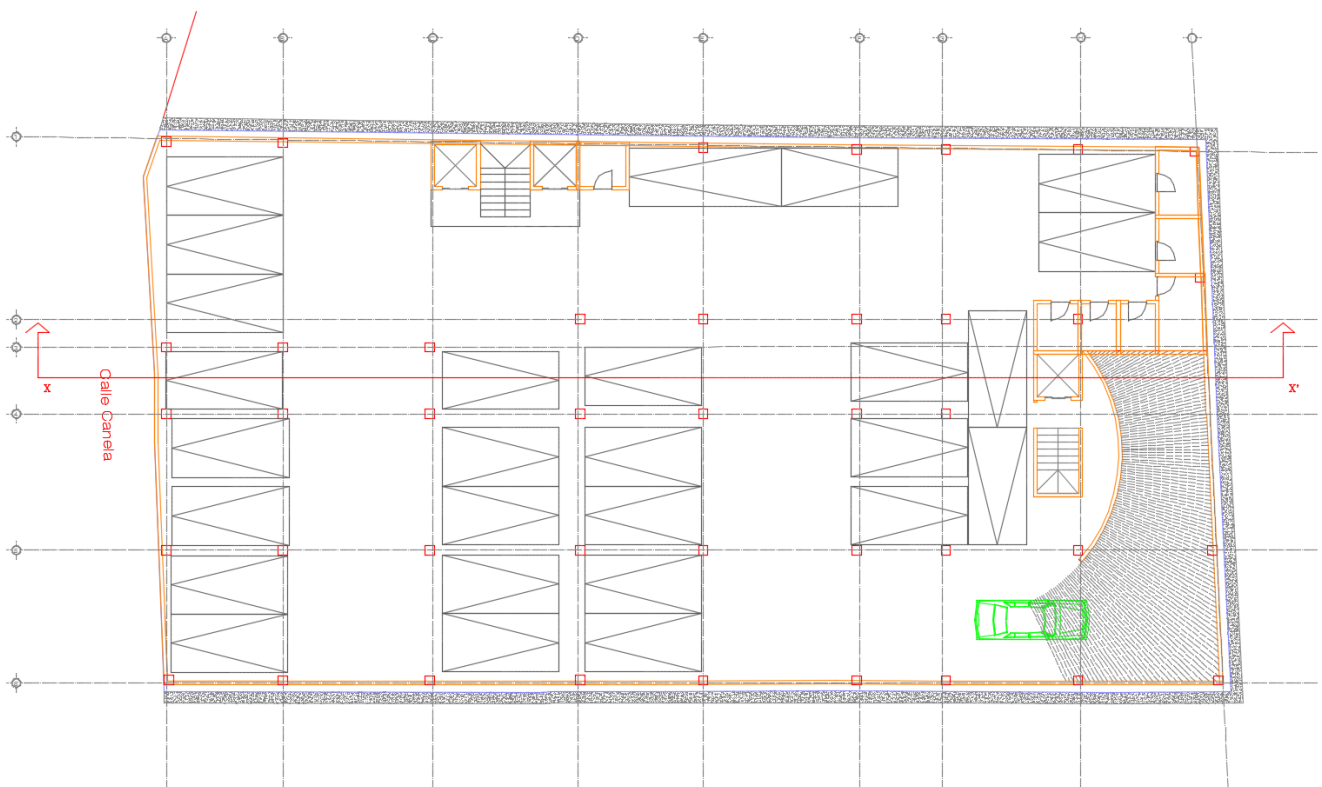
PLANTA ARQUITECTÓNICA SÓTANO 3
